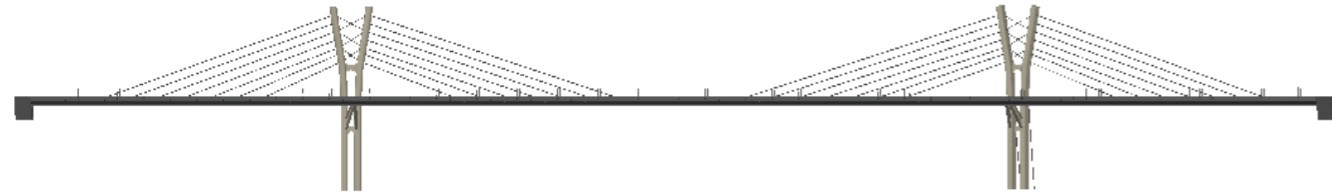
Vista en alzado de la pasarela. Fuente: Elaboración propia.
